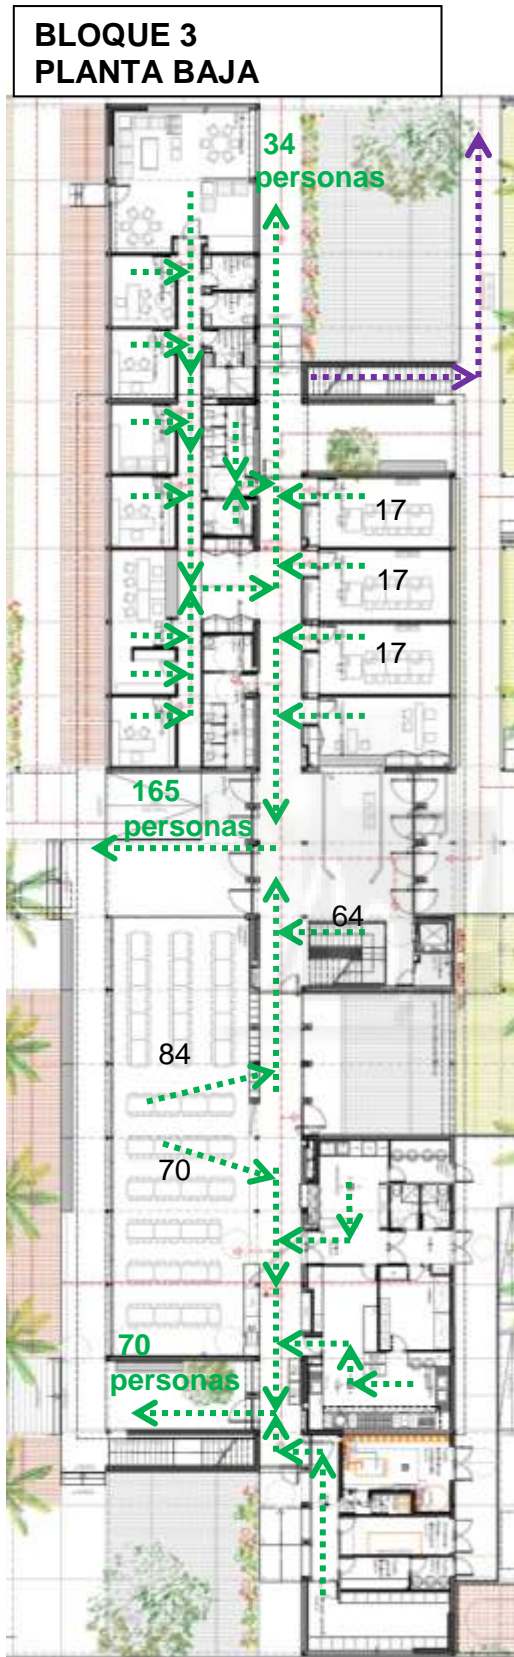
Plano Bloque 3, Planta Baja, recorridos de evacuación
